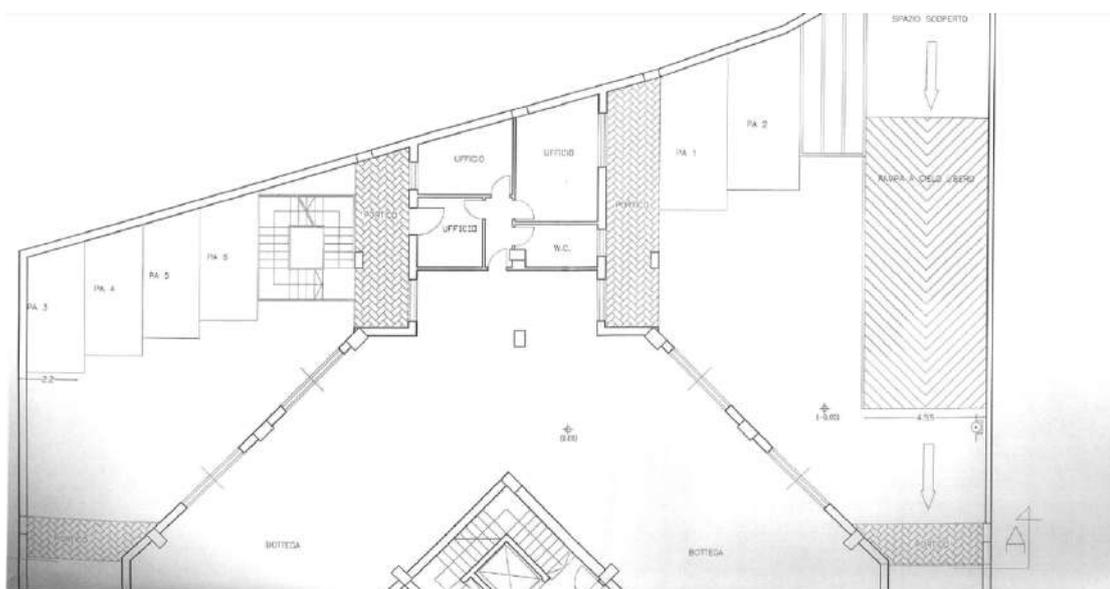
Stralcio pianta piano Terra del CPI-2009 VV.F con il posto auto sub 36 (vedi fig. 7) corrispondente al posto auto PA5 in detta pianta.
